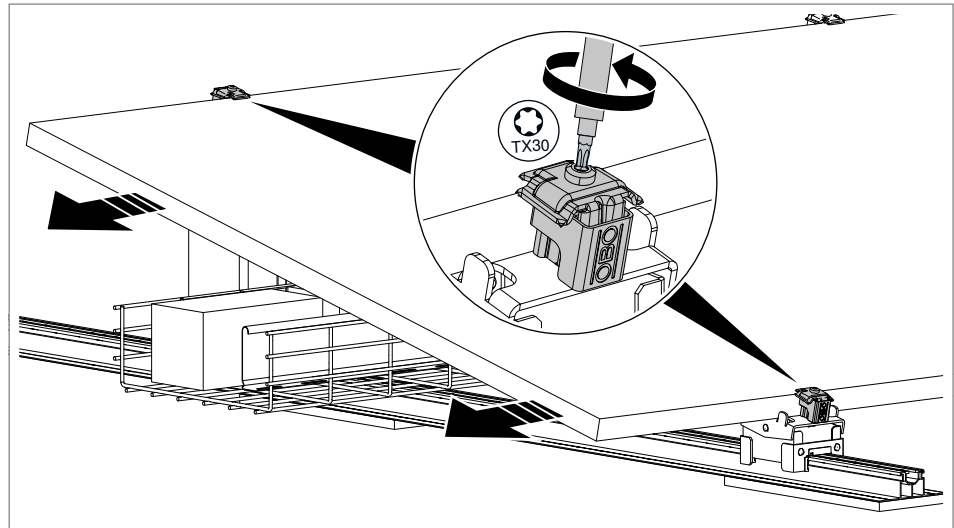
PV-Modul auswechseln, Befestigung seitlich und mittig
